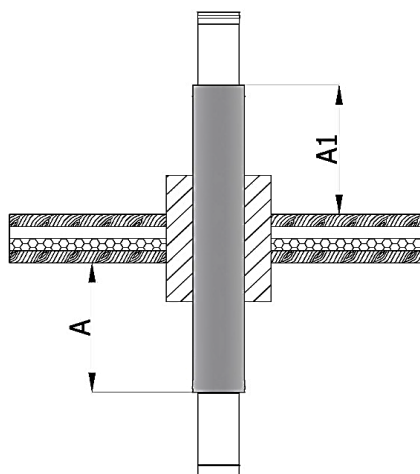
Attraversamento solaio non ventilato con passaggio a tetto
